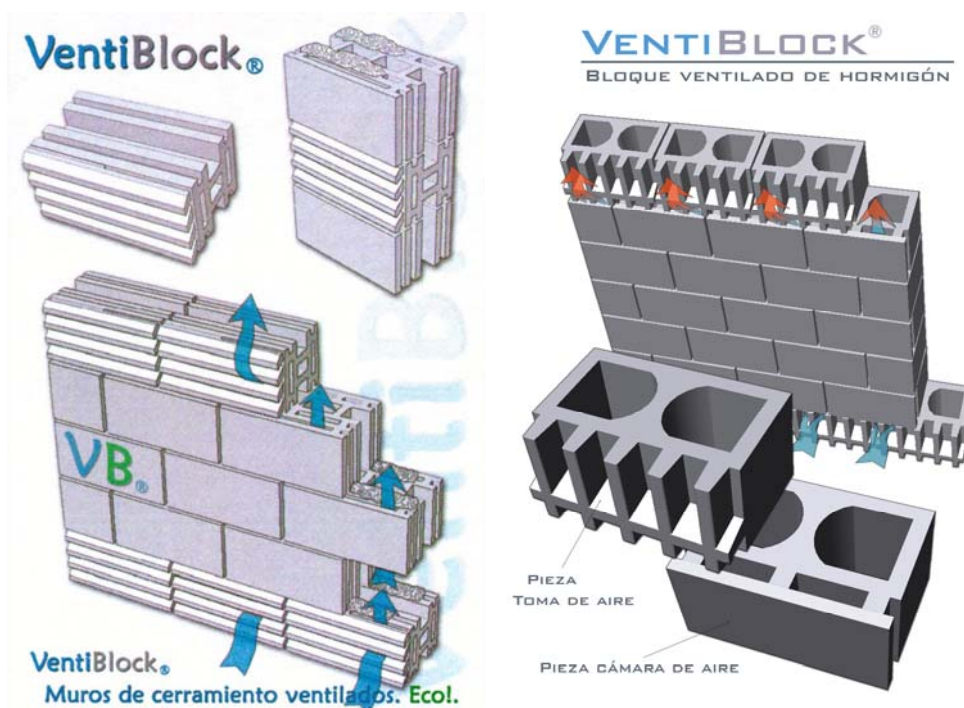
Bloques especiales de fachada ventilada VentiBlock®, difícilmente fabricables en instalaciones tipo.
